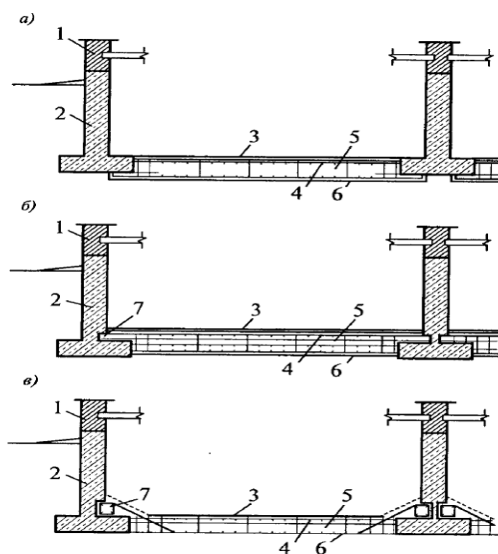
Варианты переустройства ленточных фундаментов в плитные:
